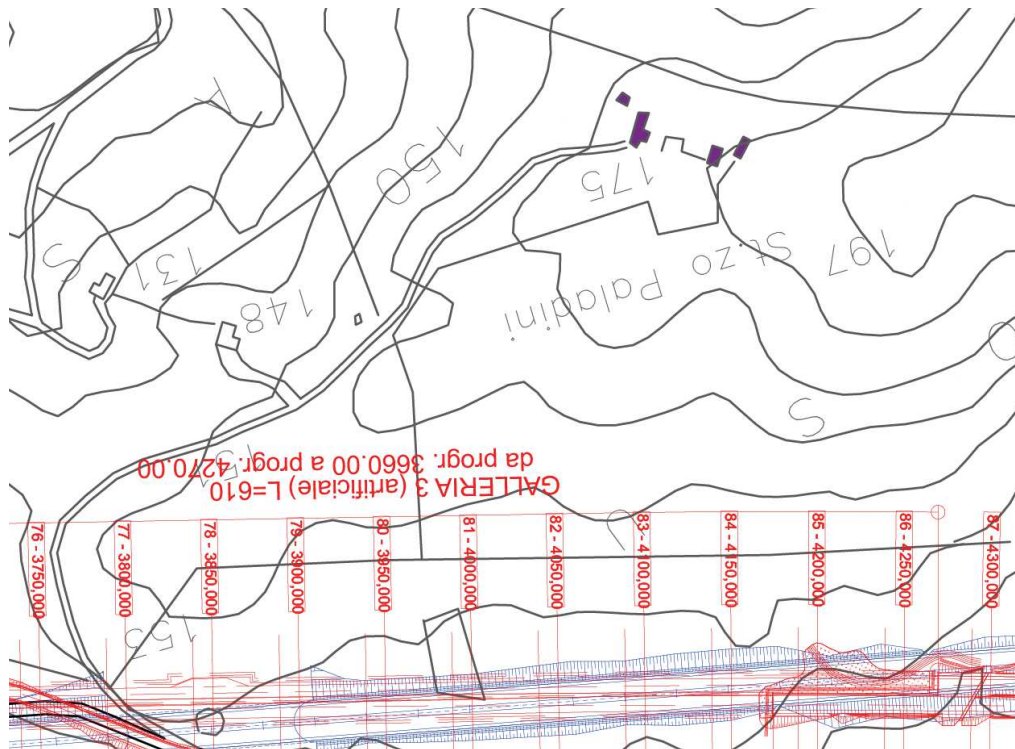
Localizzazione stazio Paladini rispetto ai tracciati
